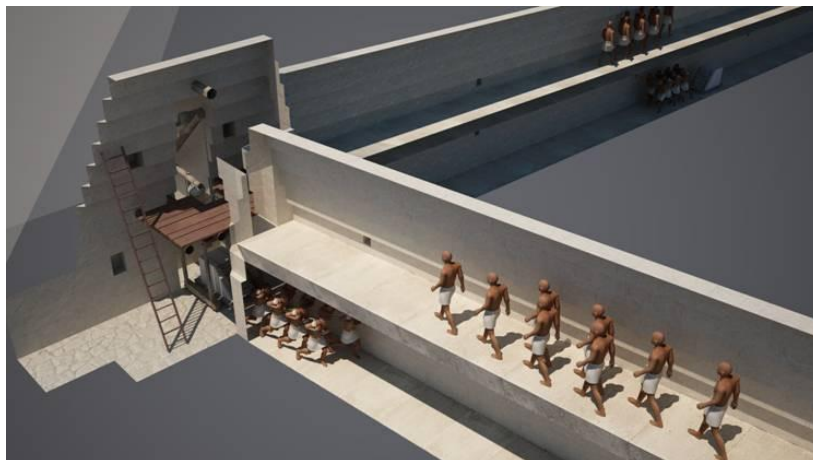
Configuration de la rampe intérieure modélisée en 3D (Houdin J-P, Dassault Systèmes)
